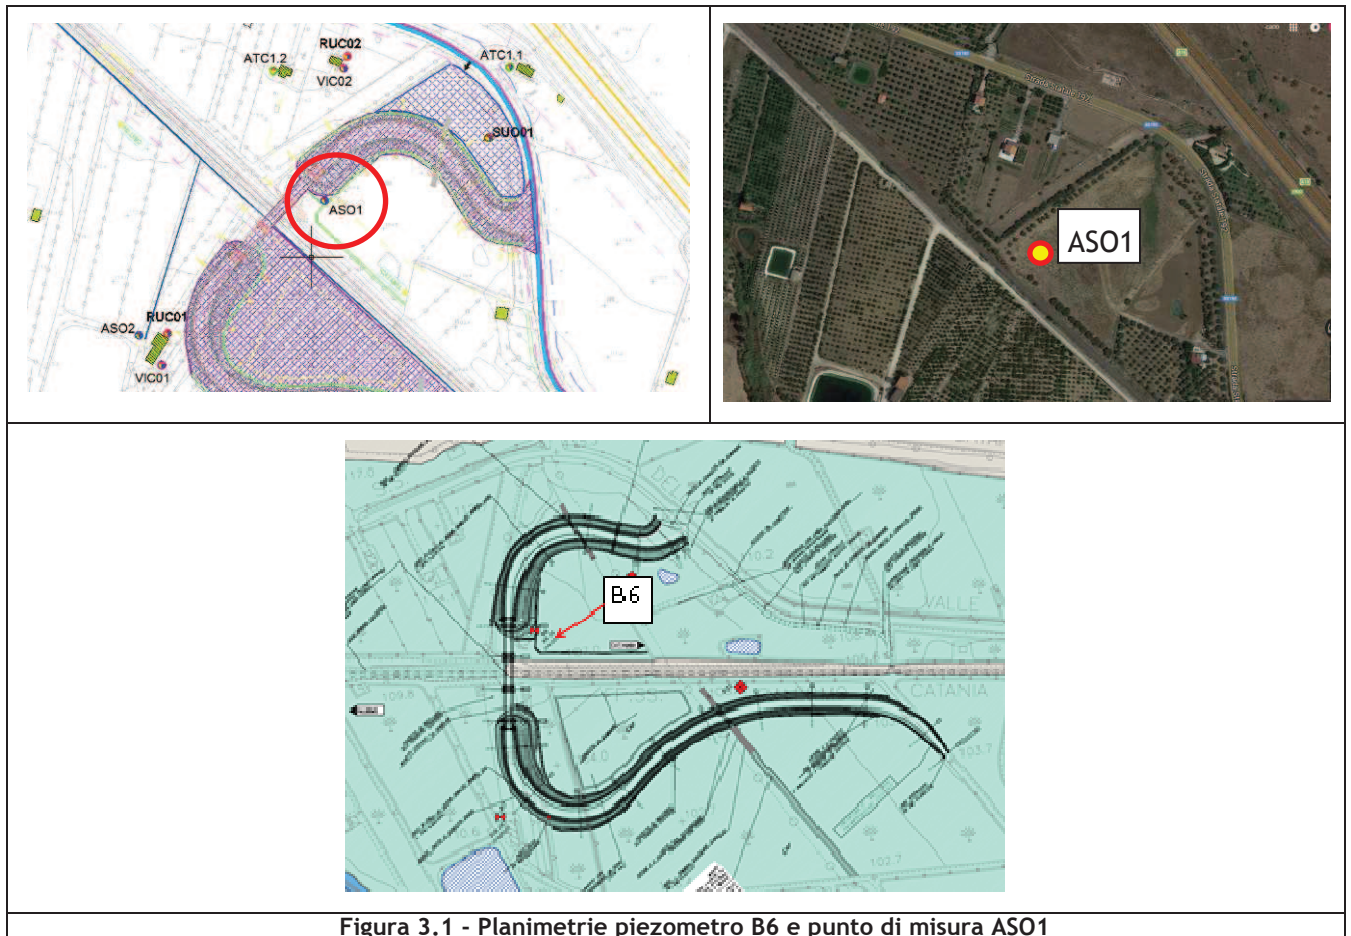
Planimetrie piezometro B6 e punto di misura ASO1
